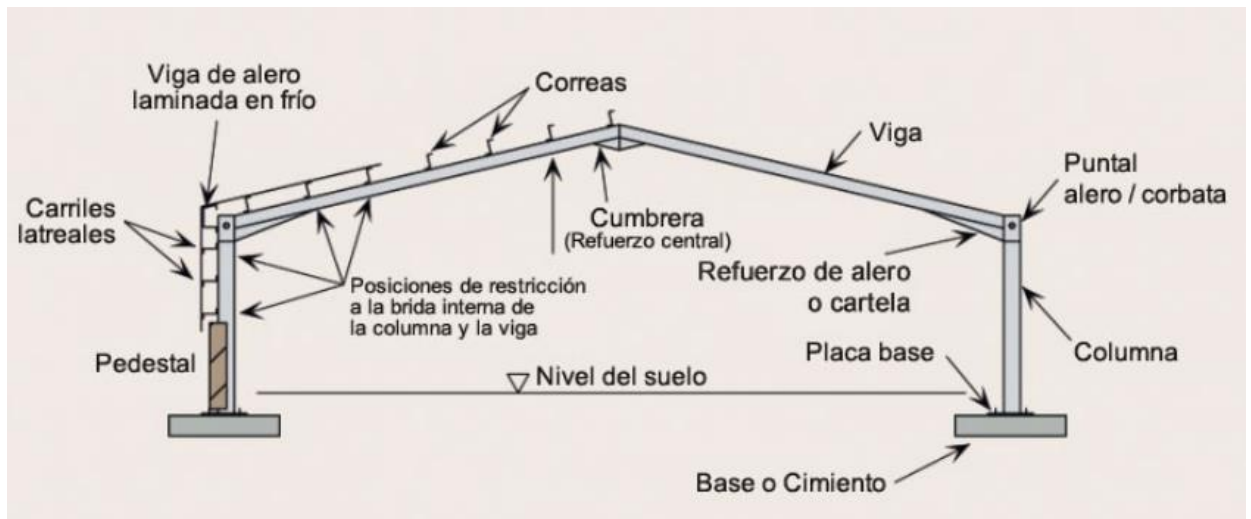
Sección transversal que muestra pórtico y sus restricciones (fuente: ingeniería & construcción s.a.)
